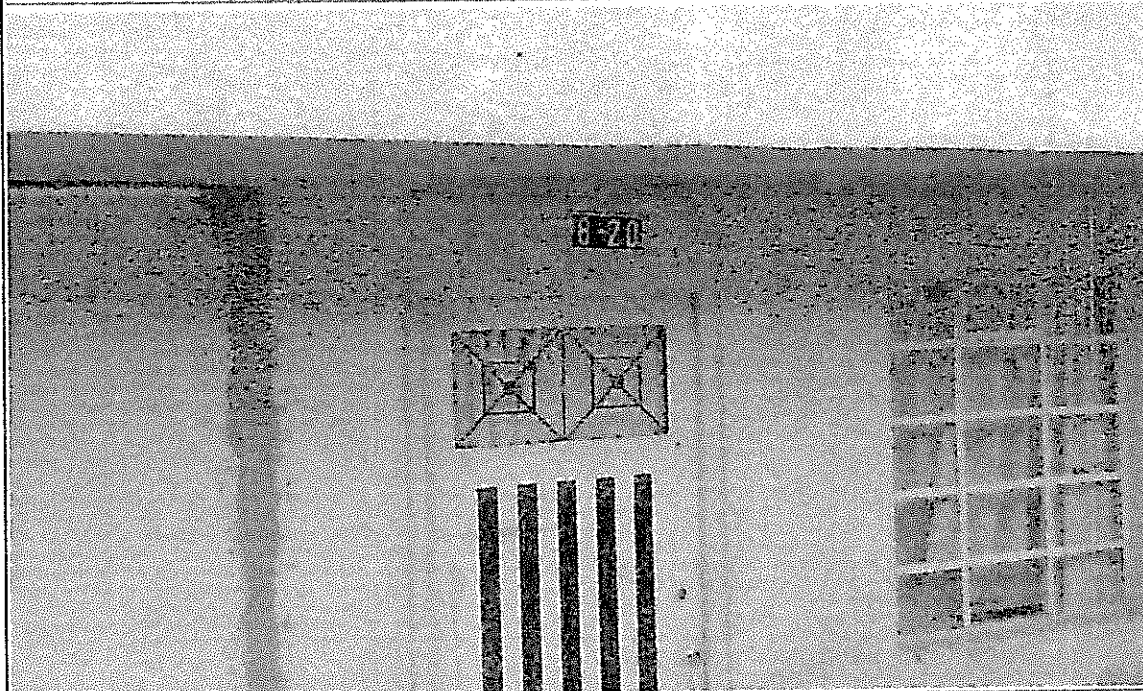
CONSTRUCCION DE MUROS DE ANTE PECHO SOBRE PLACA DE AZOTEA.
